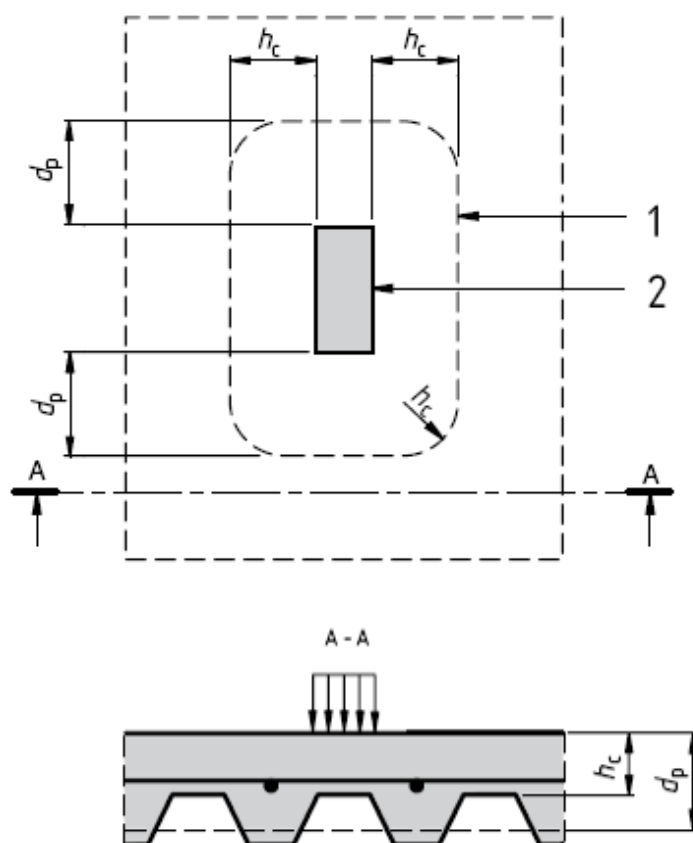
К определению площади сечения растянутой арматуры A_{sl} при работе плиты на поперечный сдвиг
